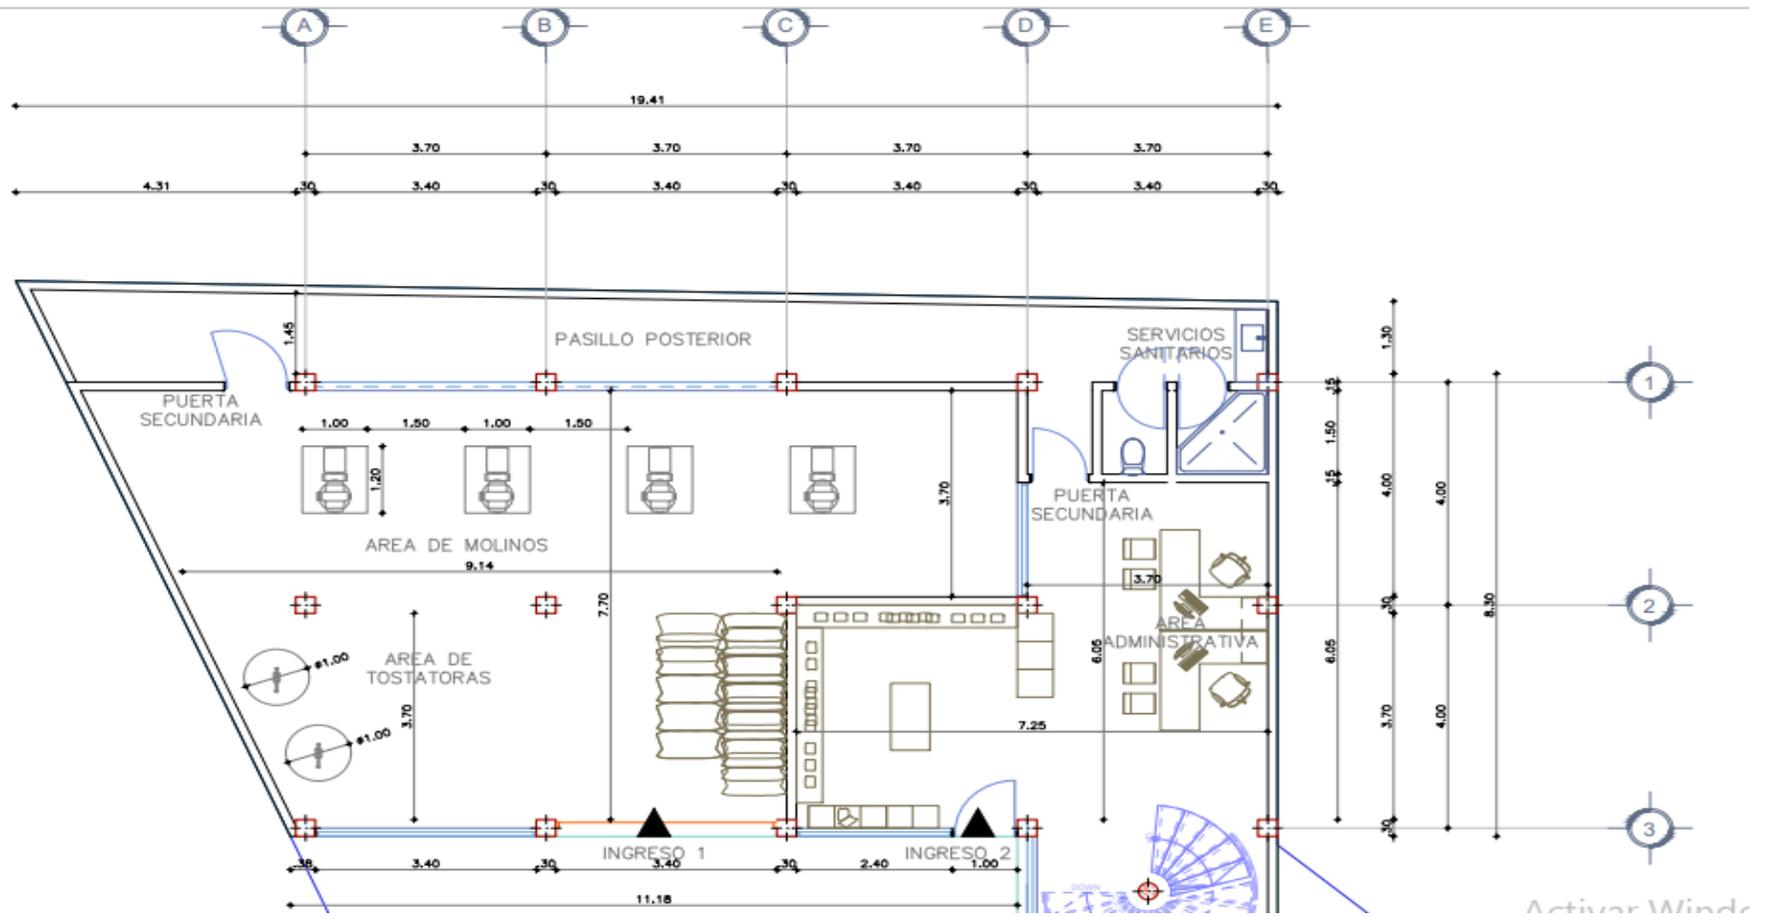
Plano de la Planta Procesadora “Molinos Aucacama S.A.”
